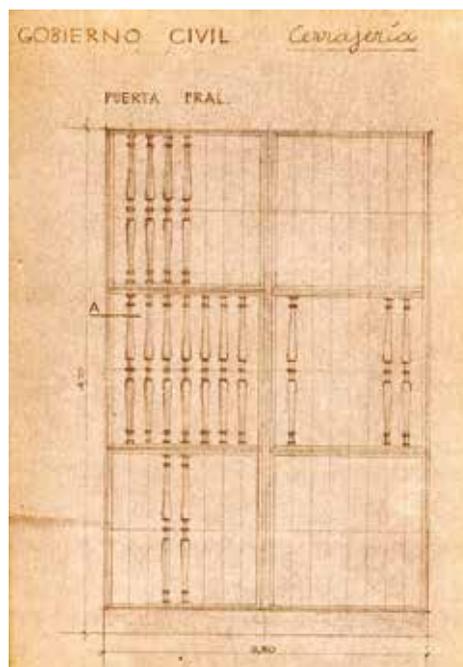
Detalle de la cerrajería diseñada por los Borobio para la puerta principal del Gobierno Civil, junio de 1954 (Archivo BAU, Zaragoza).
